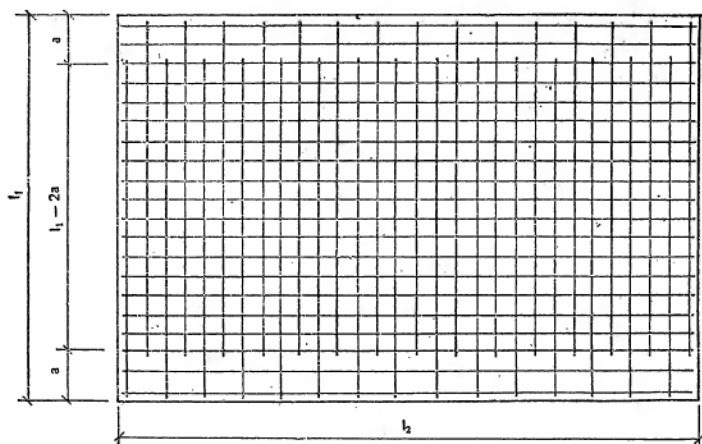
Схема к примеру расчета сборной плиты перекрытия, опёртой по контуру
